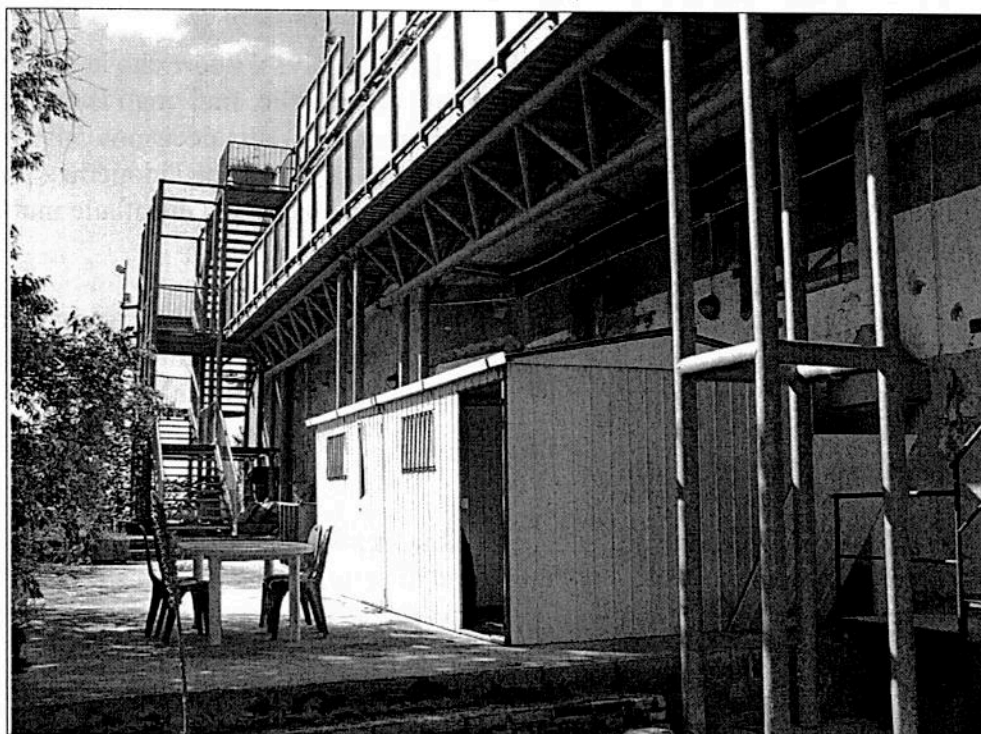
scala esterna metallica di collegamento del piazzale al piano T con terrazza lato Est del bene B2 e con la corte al piano S3, da Nord verso Sud.
